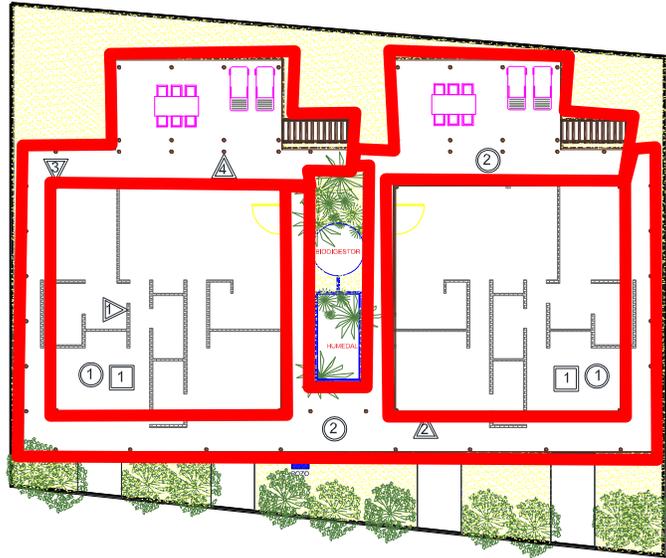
Estructuras y acabados que se pretenden para el presente proyecto.
